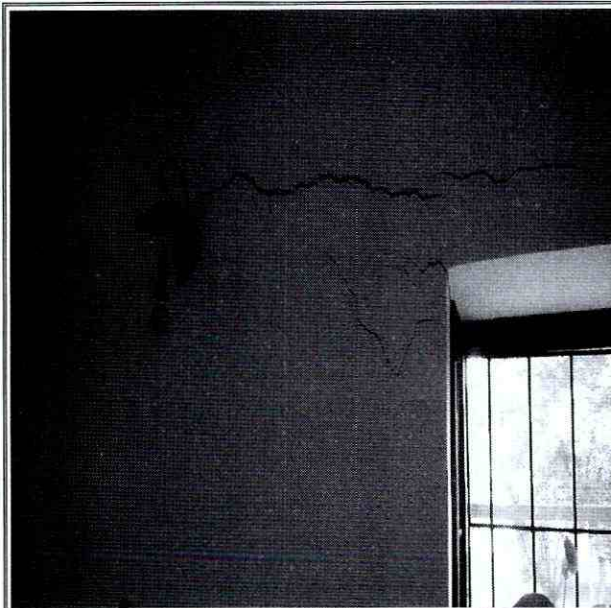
Grietas muro perimetral primer nivel costado sur de la vivienda
